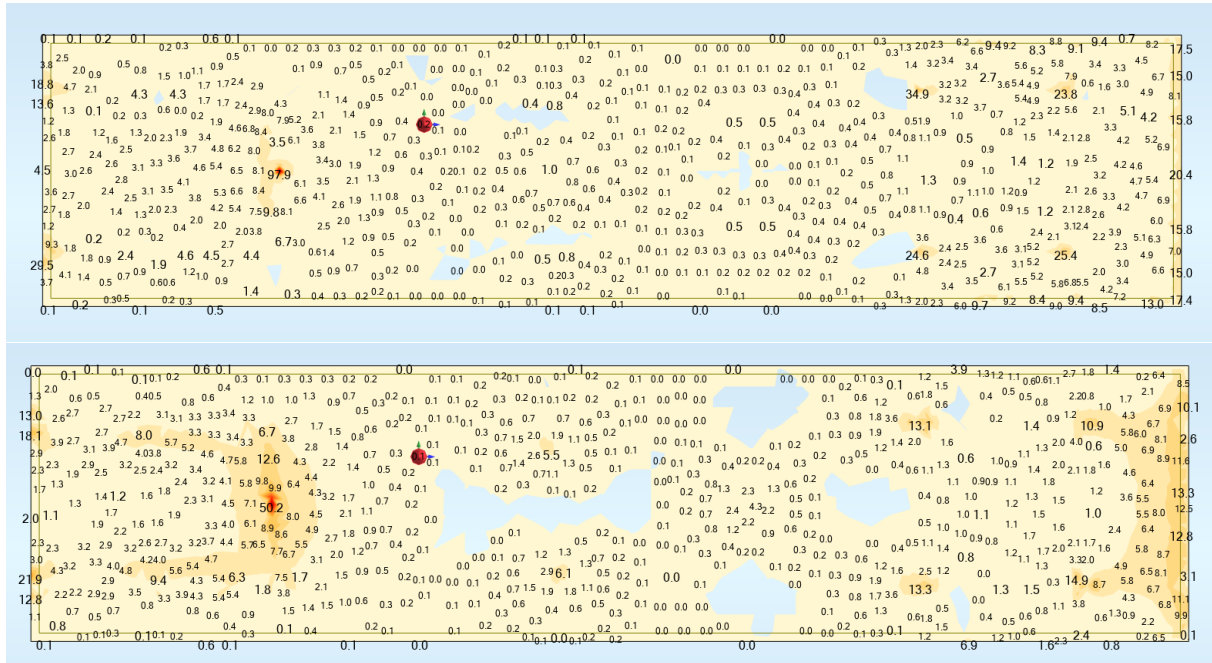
Armadura longitudinal inferior/superior y transversal inferior/superior
